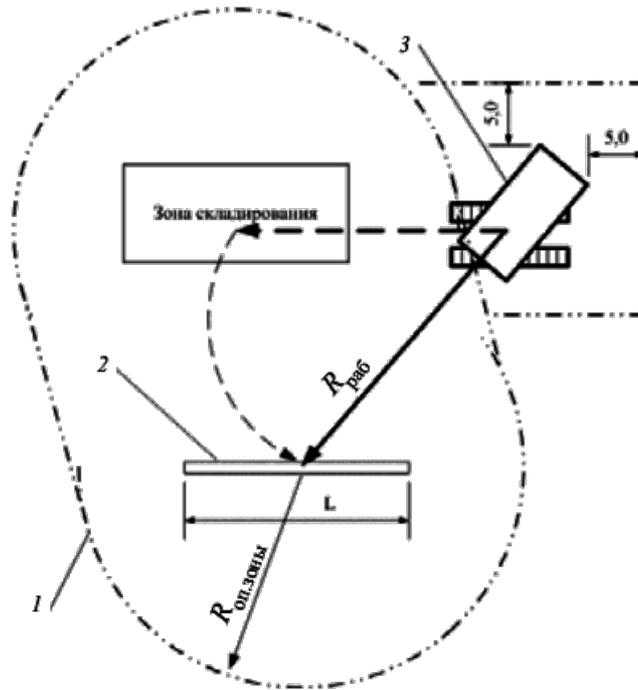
Расчетная схема определения опасной зоны при перемещении груза краном:
